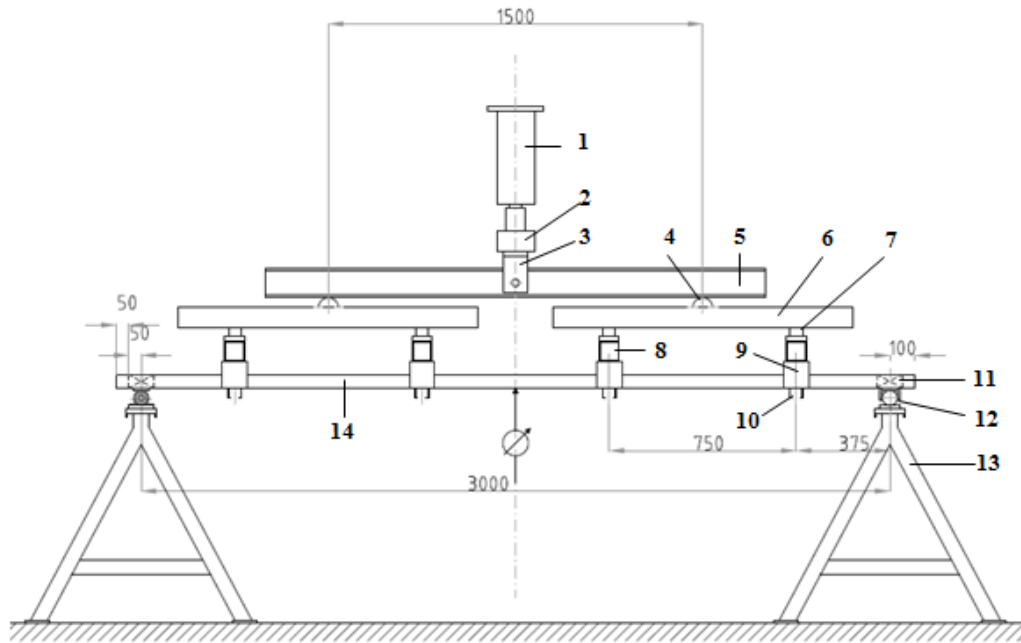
Alzado longitudinal. Montaje de ensayo.
